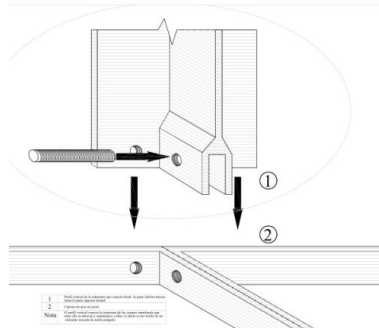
Detalle de ensamble entre columna y viga. Autor: Omar Acuña. 2014.
